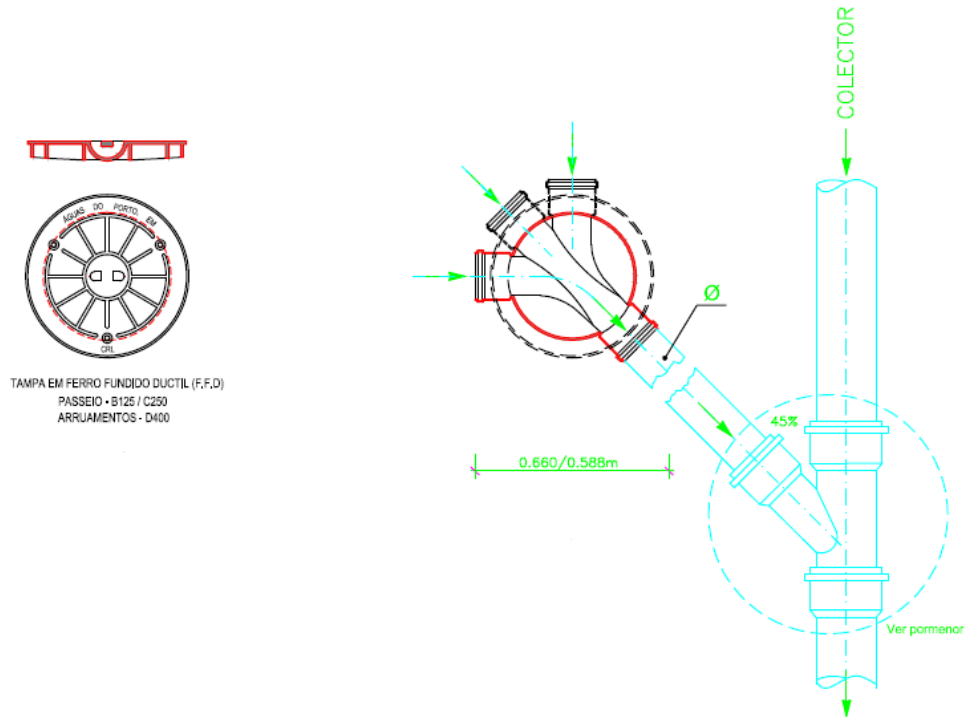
Câmara em polipropileno corrugado de parede dupla - Planta.
